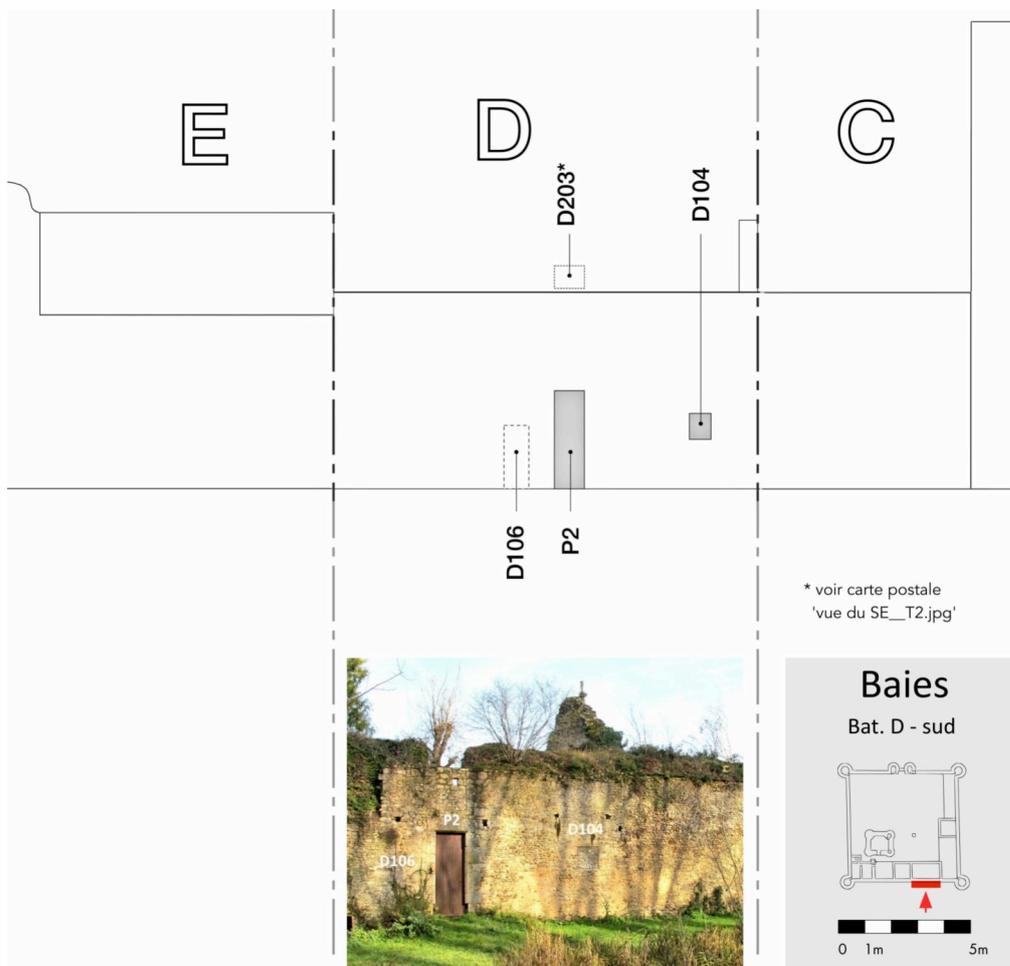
Nomenclature des baies du bâtiment D, façade est (DAO : Xavier Bignon / ADM).
